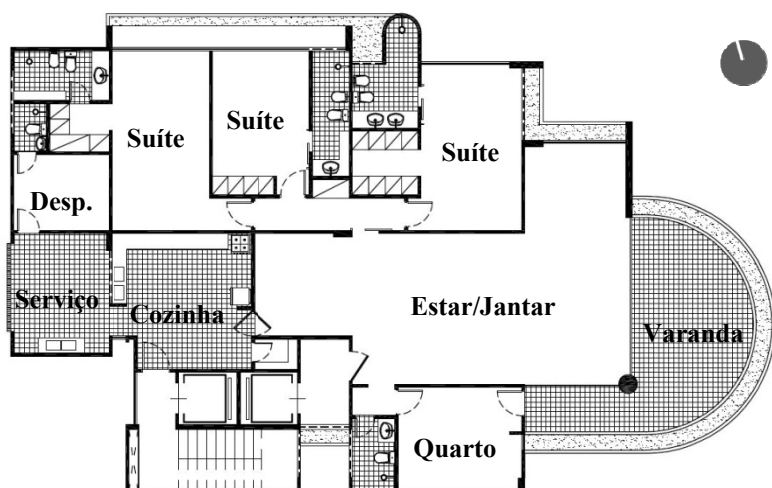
Planta baixa do edifício. Esc. 1/250. Fonte: os autores
